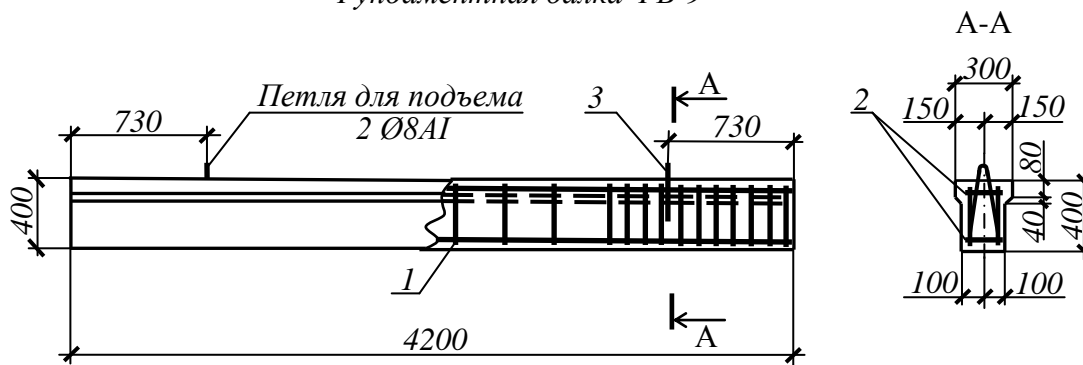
Пример схемы армирования железобетонной фундаментной балки
